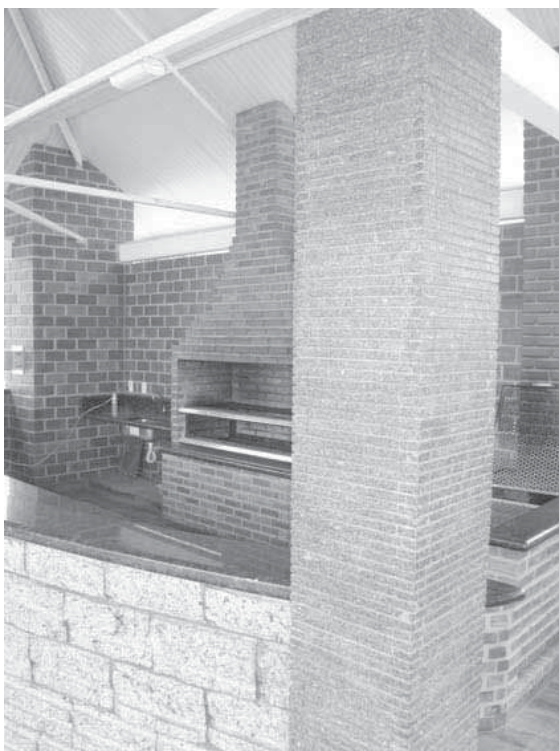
Colunas em tiras, balcão em casqueiro assente com a face corrugada para o exterior. Obra Jaciguá. 2006 (foto do autor).
